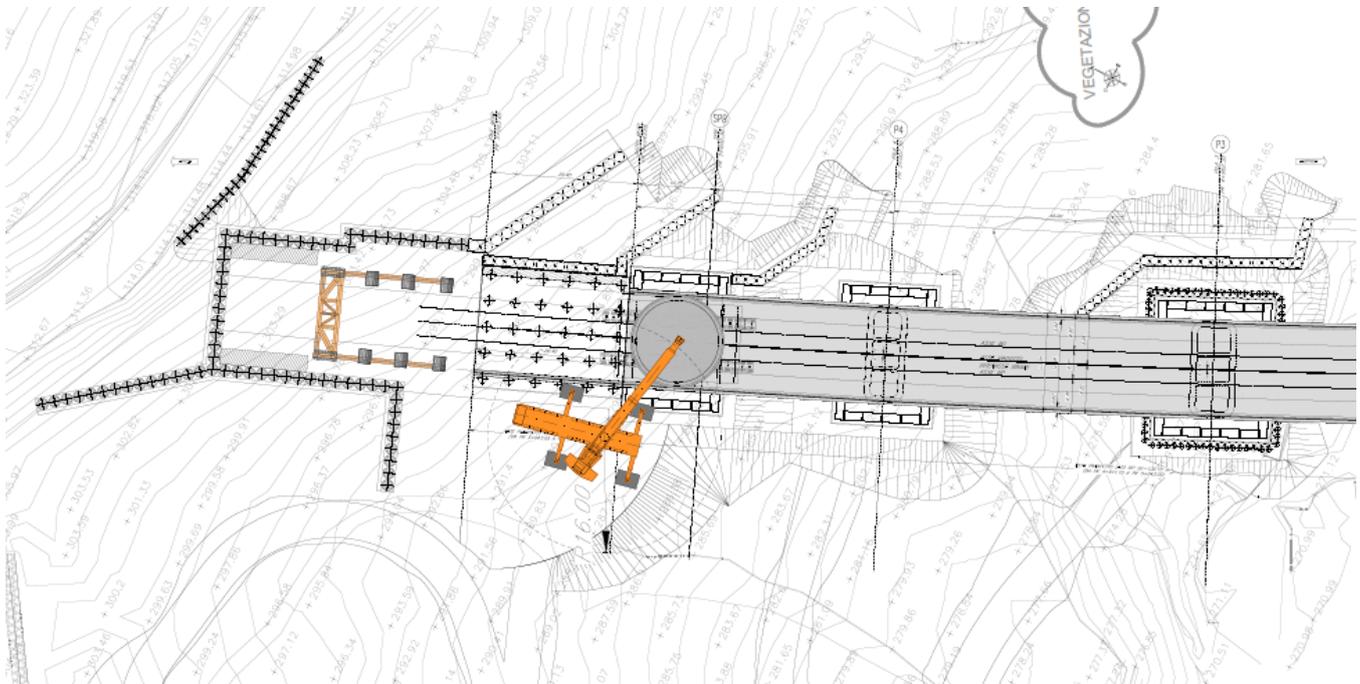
Traslazione TBM lungo il viadotto VI02 – Smontaggio e traslazione lato Galleria Grottaminarda-Pianta
